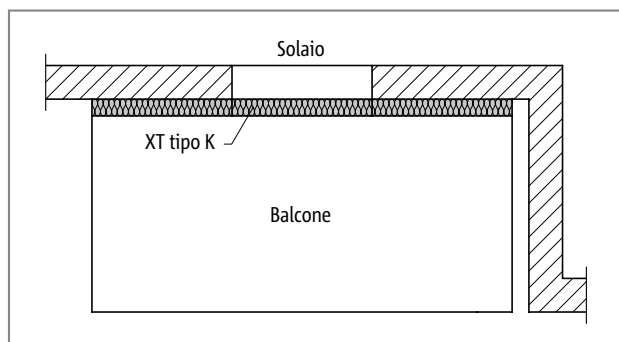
Schöck Isokorb® XT tipo KL: pianta
